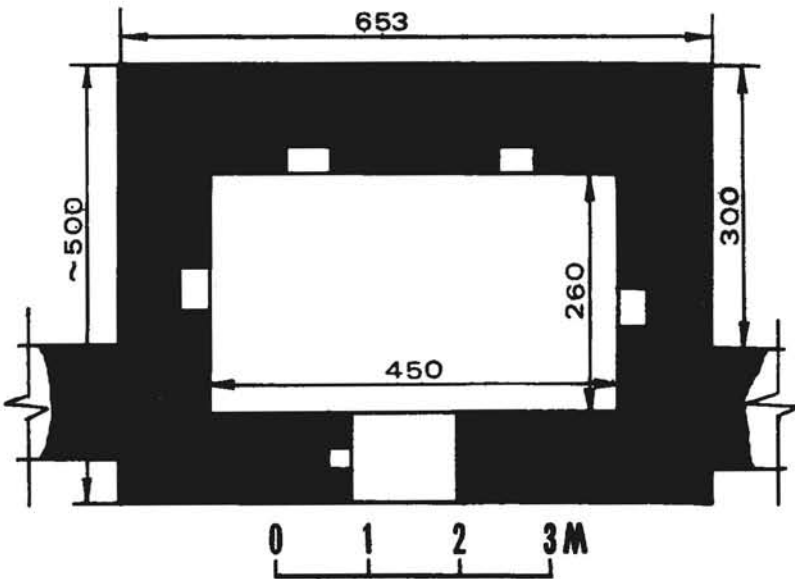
Grundriss des im 13. Jh. gebauten Ramerturms.
